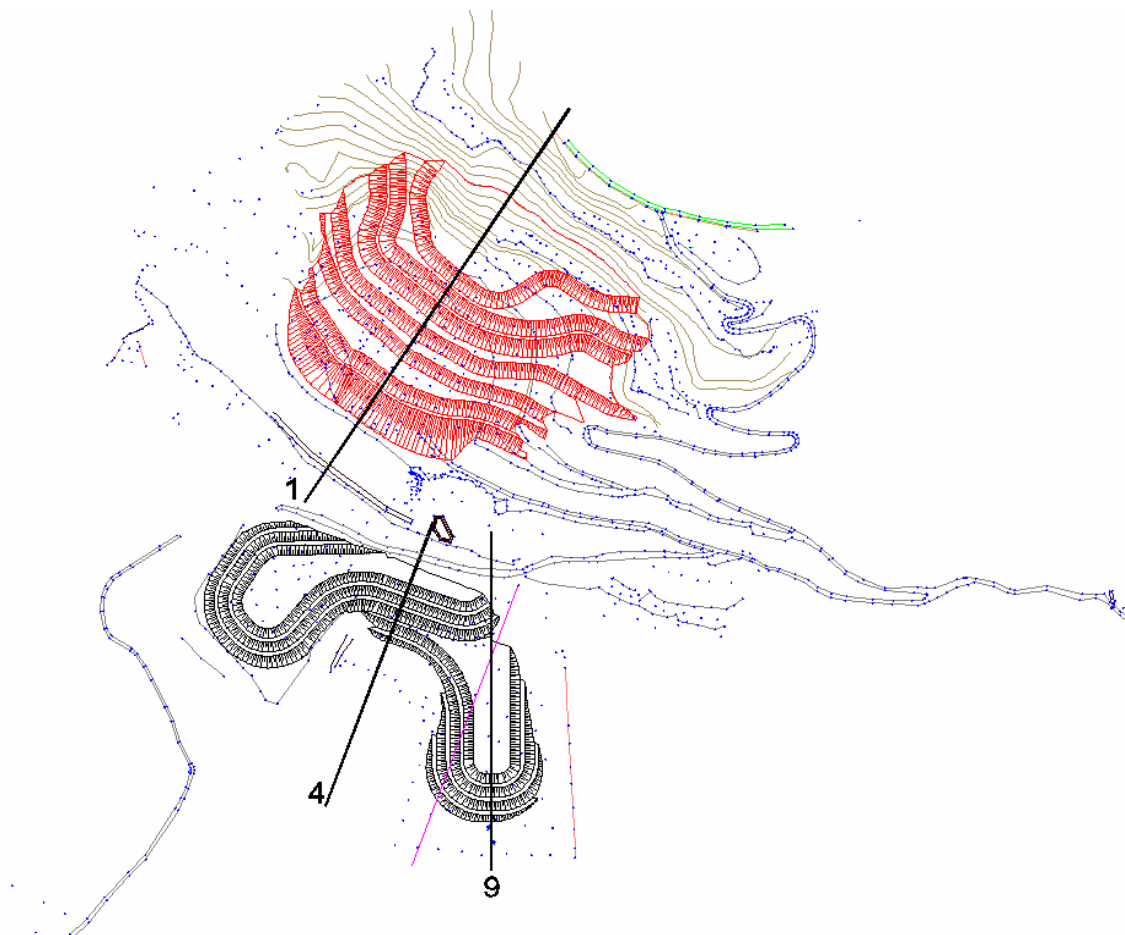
Planimetria del deposito con indicazione delle sezioni di calcolo
